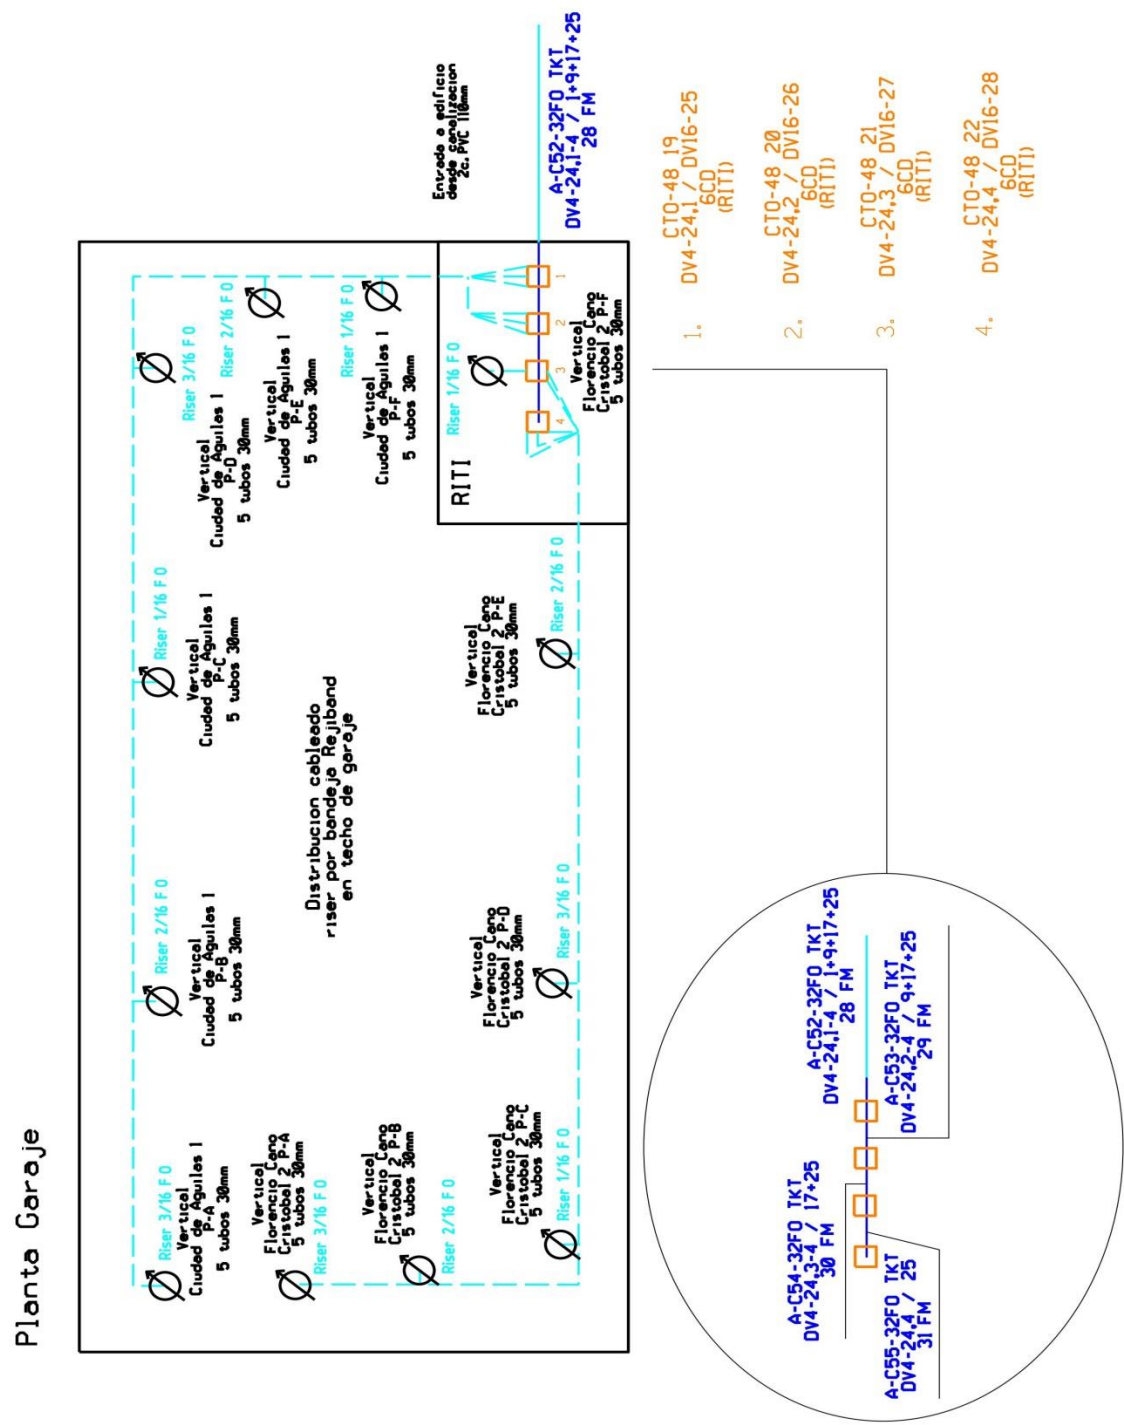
Plano de interior de la planta garaje C/Florencio Cano Cristóbal 2 y C/Ciudad de Águilas 1
